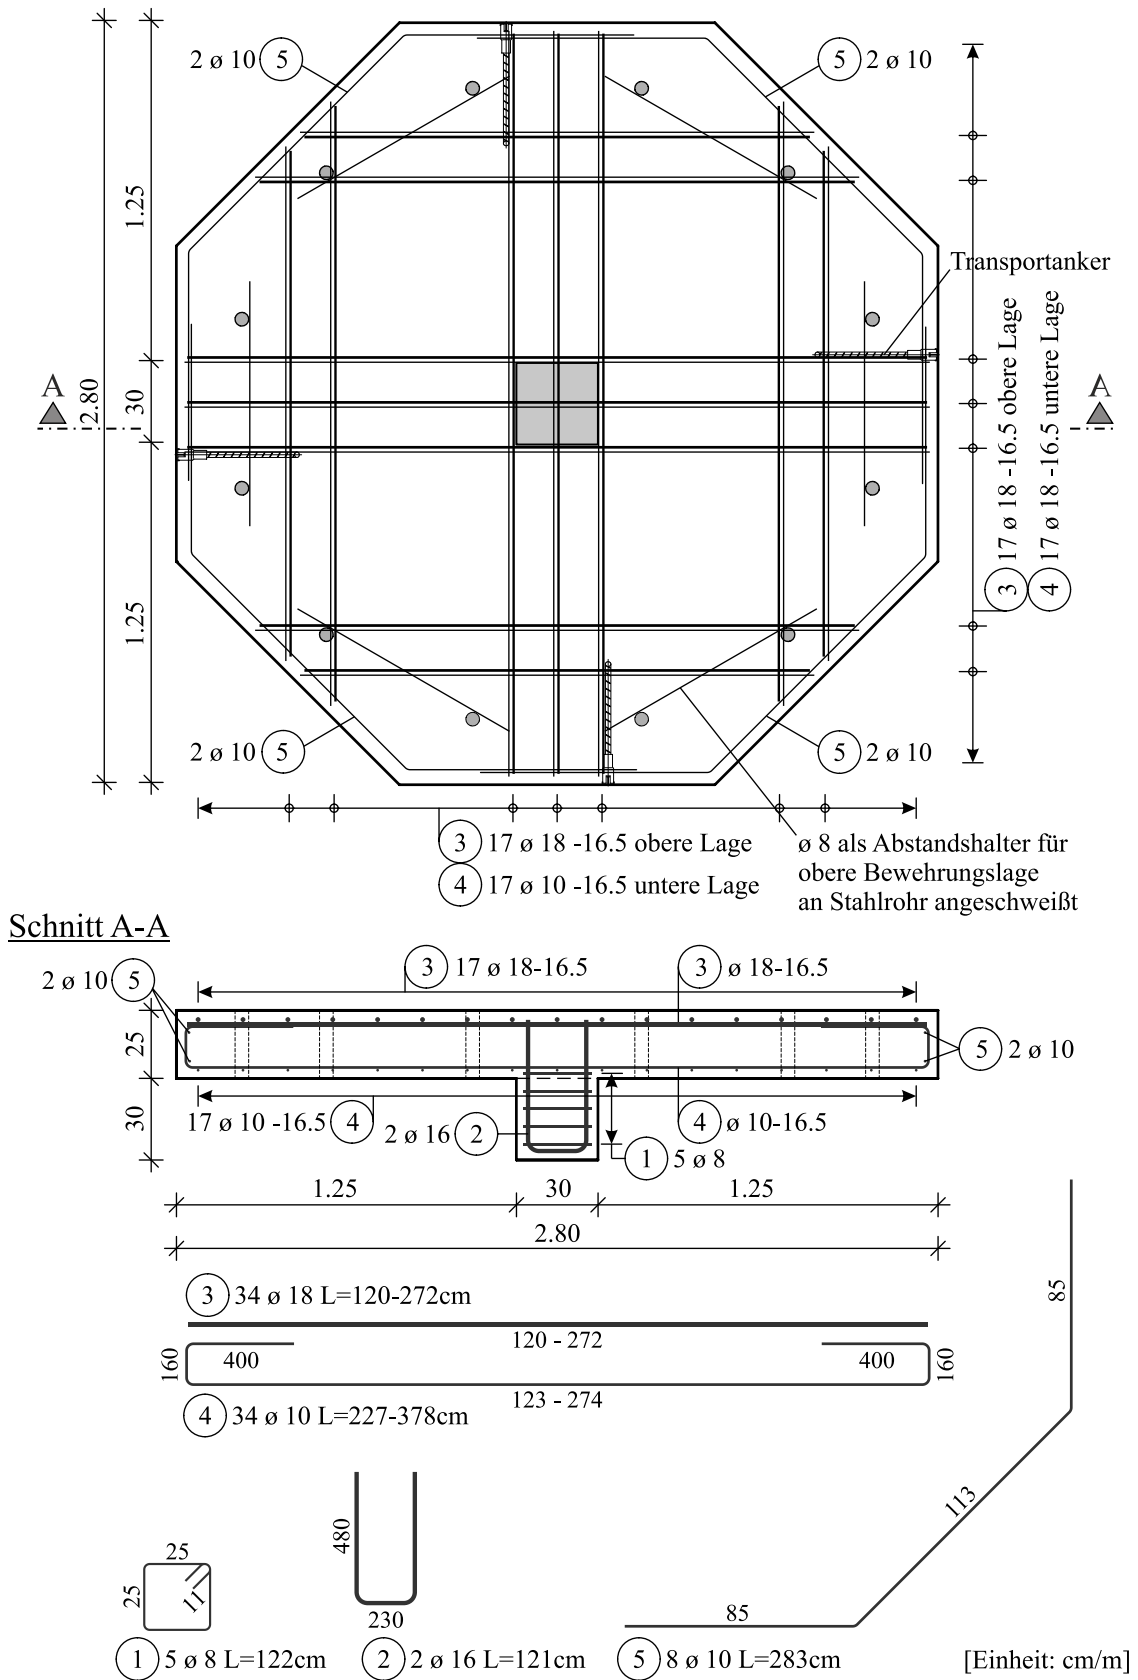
Bewehrungsplan des Versuchskörpers M3-25-0.75
